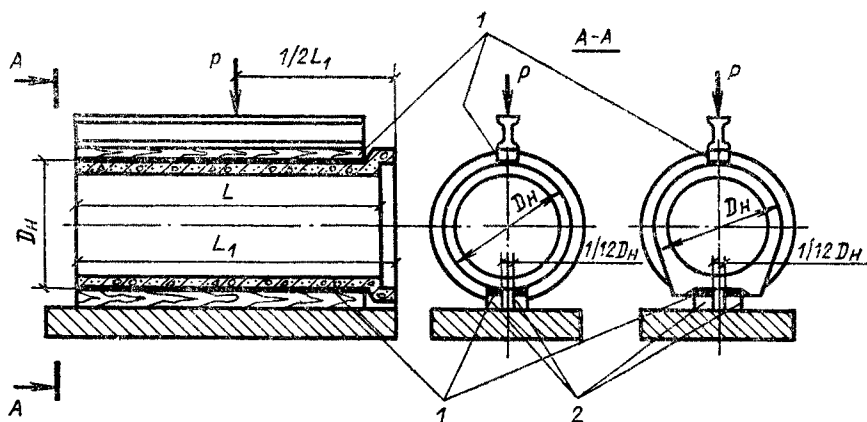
Схема испытания железобетонной фальцевой трубы
